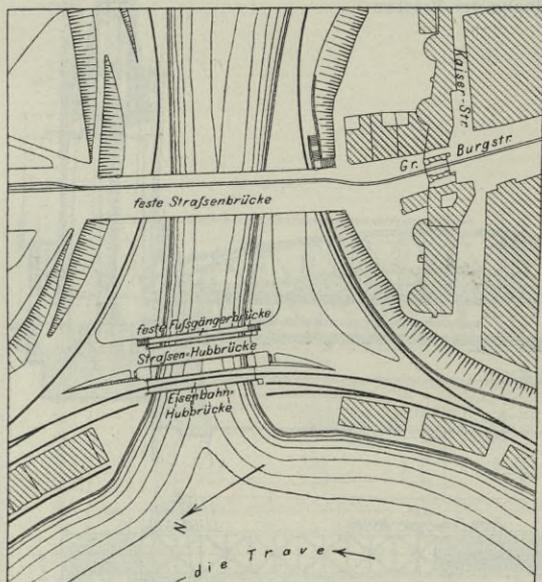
Lageplan der Hubbrücken in Lübeck.
